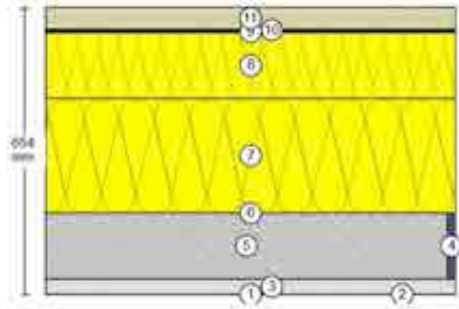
Bauteil, Dachbeläge, Decke Neu\_15cm
